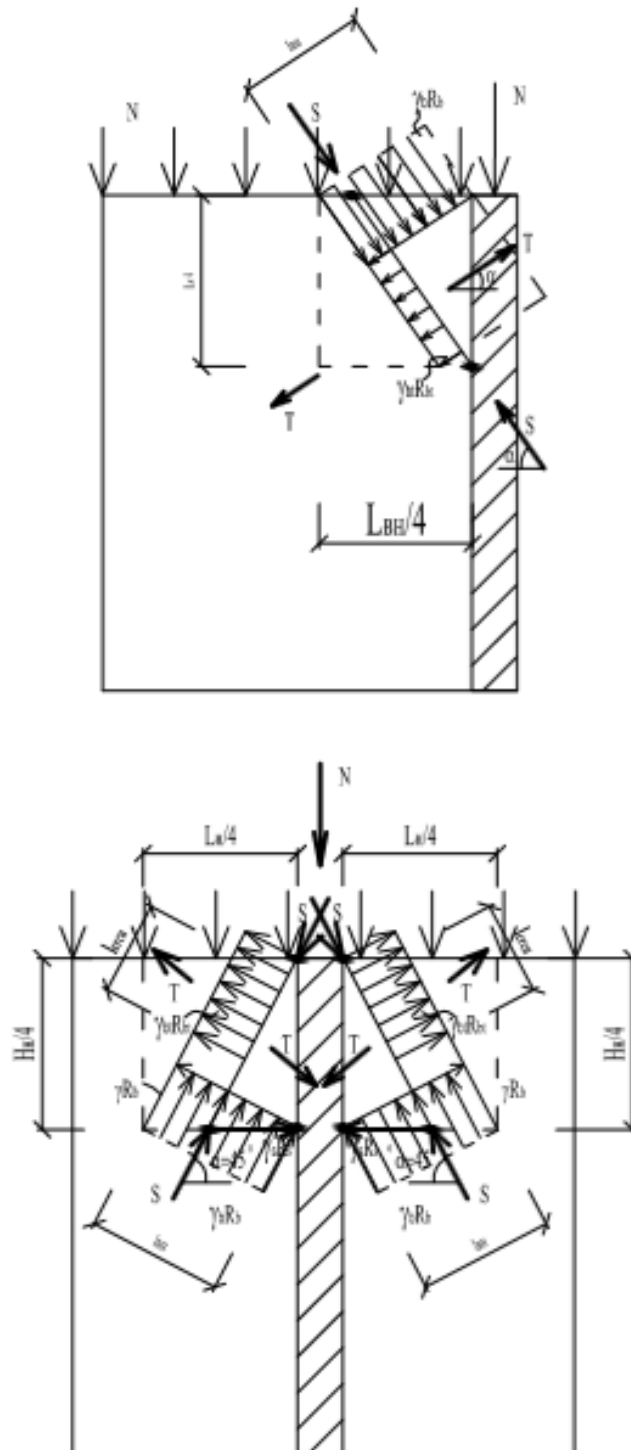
Расчетная схема узла сопряжения разнотолщинных стен при одновременном нагружении внутренней и наружной стен на основе каркасно-стержневой модели
